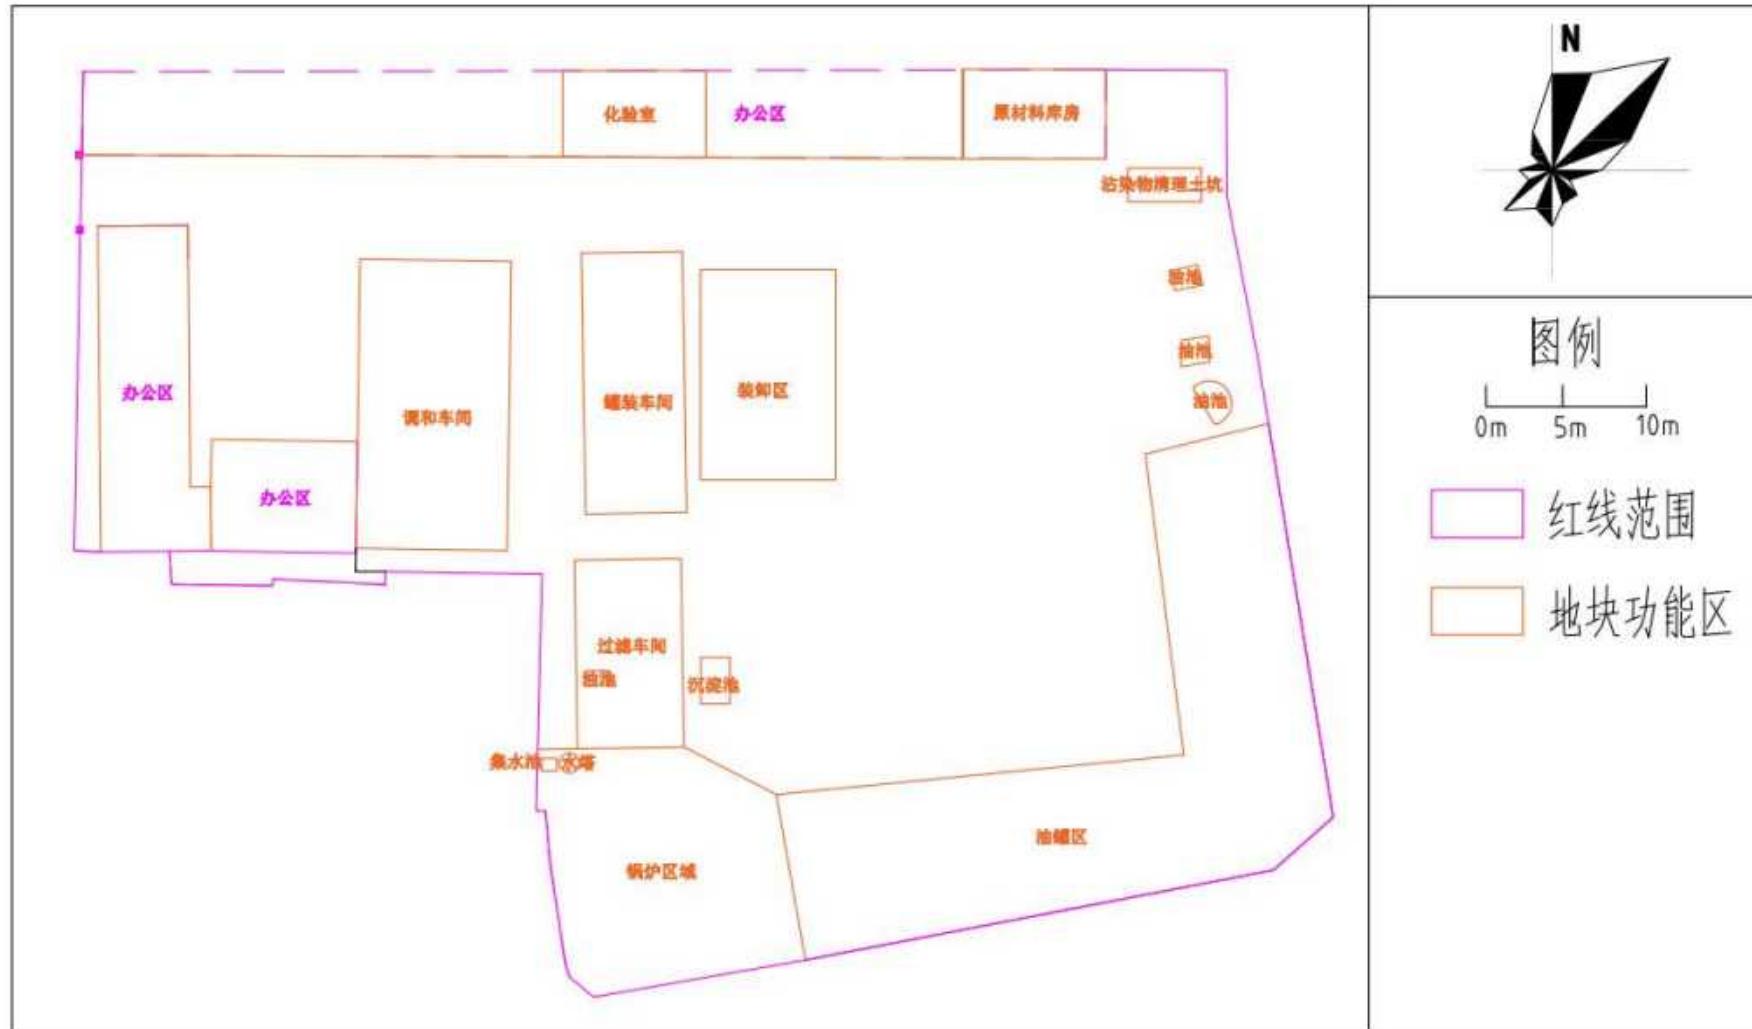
富可斯润滑油有限公司地块（老厂）平面布置图
